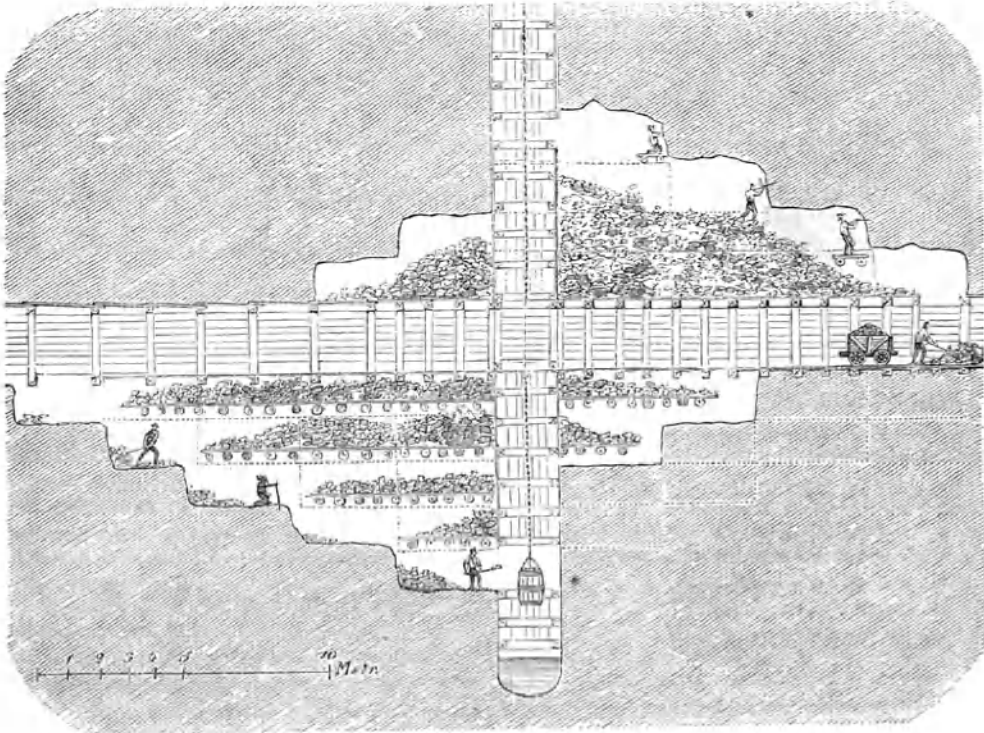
Stroffen- und Forstenbau mit Zimmerung in Schacht und Strecken.
